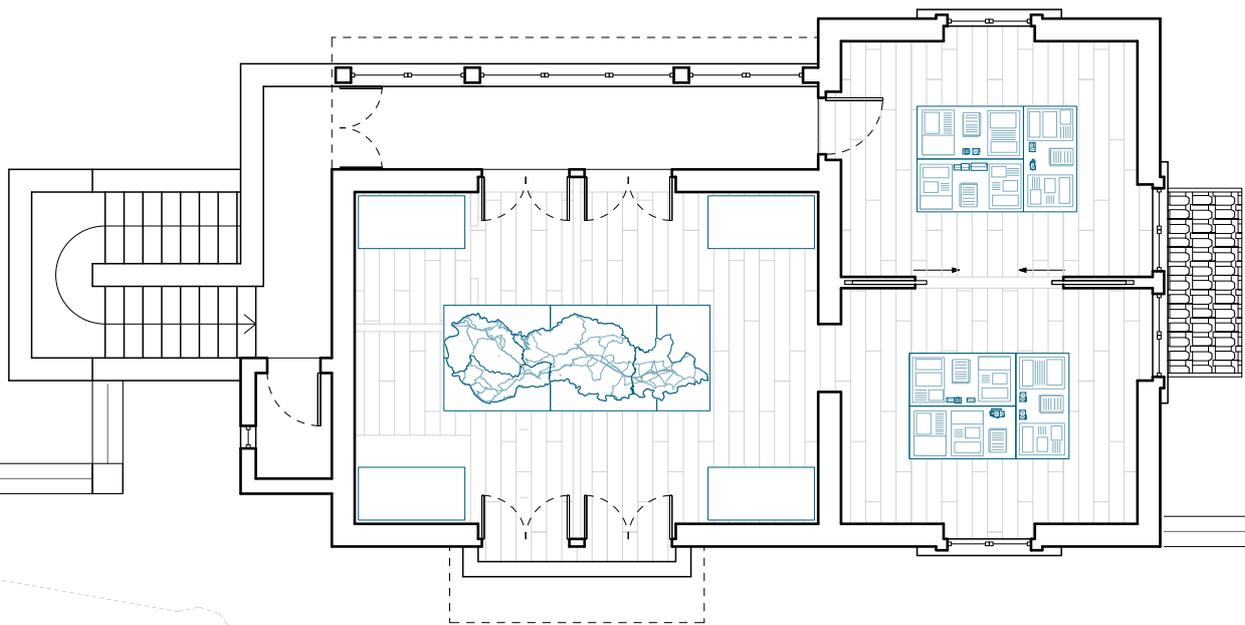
Plantas do Edifício de Passageiros - Primeiro Piso
